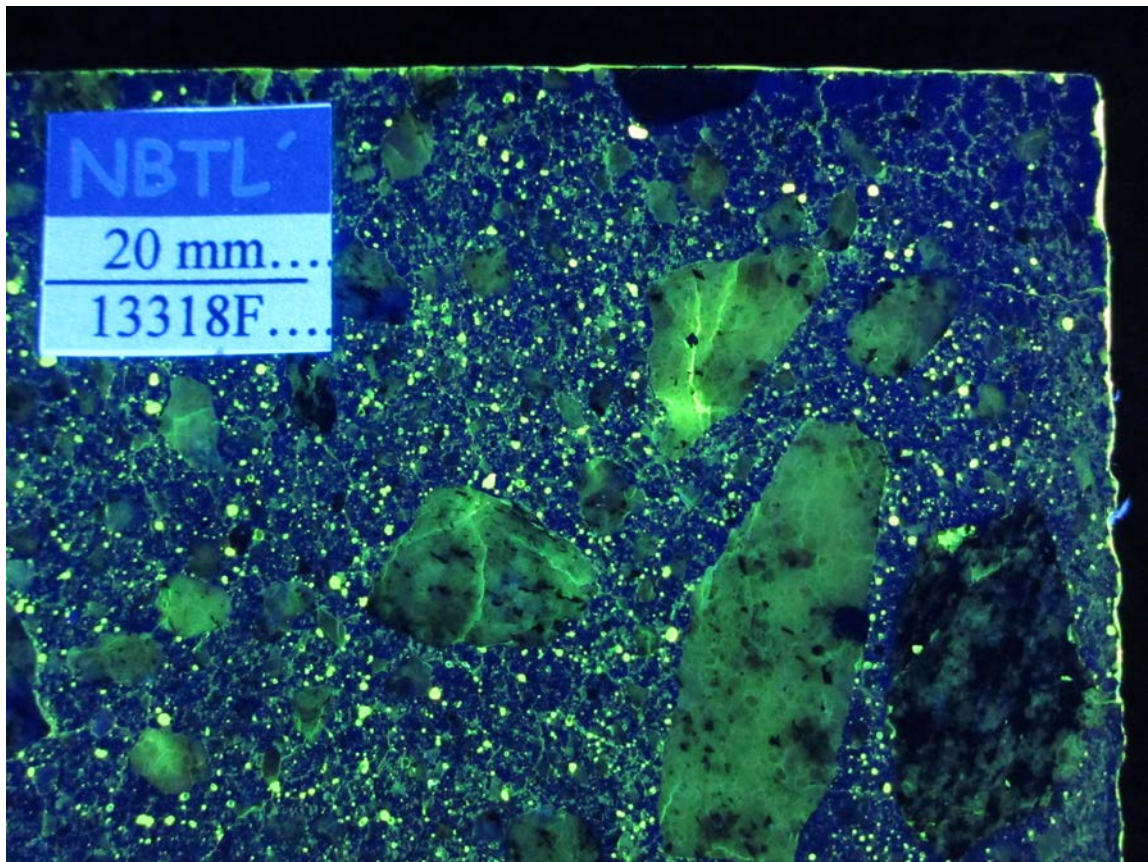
Planslip 13318F i UV-lys, detalj. Merk riss i flere granitt tilslag
